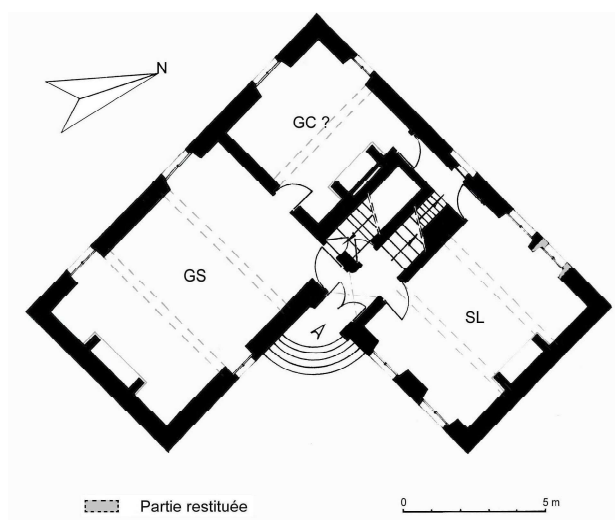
Jouveaux. Plan restitué du rez-de-chaussée vers 1590.
